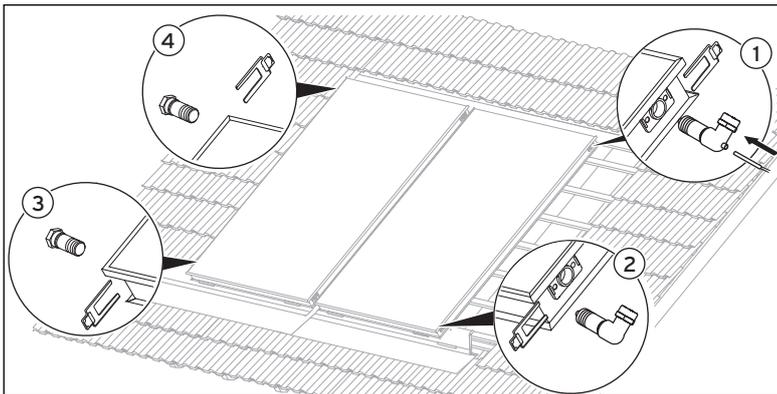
Hydraulische Anschlüsse montieren (1-5 Kollektoren)
